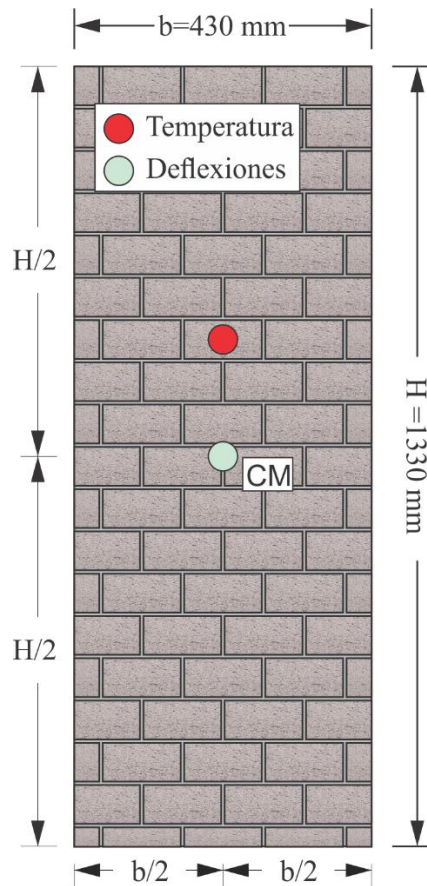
Esquemático de muro de concreto normal con referencias de medición.
